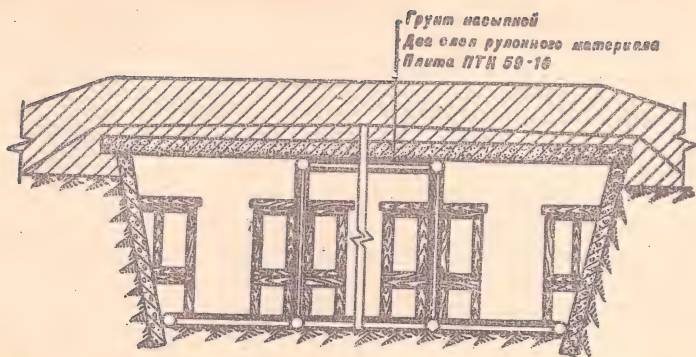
Трехпролетное убежище (укрытие) с деревянным несущим каркасом (пространственной рамой) посередине и распорной рамой понижу
